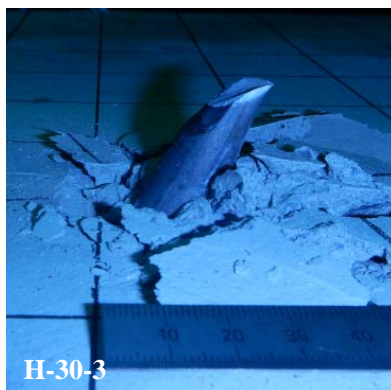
(d)~(f)にコーン状破壊の状況を示す。コーン状破壊は、前述以外の試験体で見られた。またこの破壊では加力方向 θ が0度のひび割れは、破壊と同時にコンクリート上面のへりあき方向と、側面ではアンカーボルト材軸方向、及びアンカーボルトの頭部から加力直交方向の左右に生じた。加力方向 θ が30度, 60度では、へりあき距離 c が75と小さいと、配筋の有無に関わらず破壊前で最大0.2mmのひび割れがコンクリート上面に生じた。へりあき距離 c が200の試験体では、破壊前のひび割れは確認されなかった。主要なひび割れは破壊と同時に現れ、コンクリート上面のへりあき方向と、側面ではアンカーボルト材軸方向、及びアンカーボルトの頭部または先端を中心に加力直交方向に沿って生じた。また、配筋された試験体のコンクリート上面の加力方向では直線状の割裂ひび割れが見られた(写真 4.1(c))。
